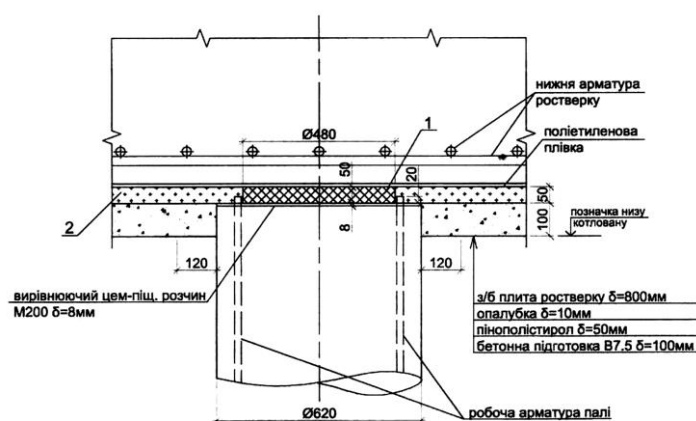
Схема размещения РСБ на свае системы виброизоляции секций №1 и №2 жилого дома по ул. Киквидзе в г. Киеве
